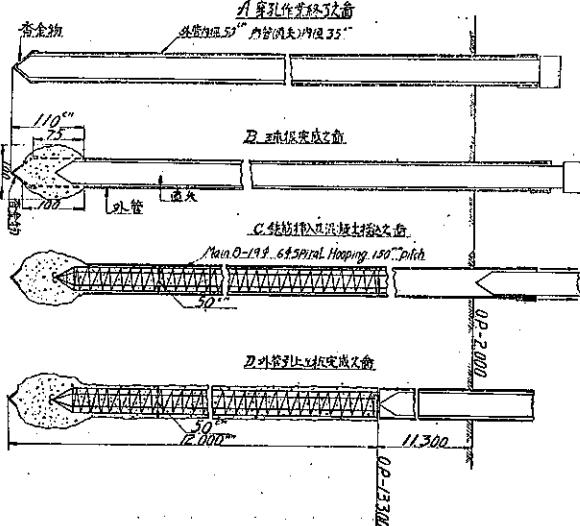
大阪駅構内地下鉄潜函基礎杭施工圖
